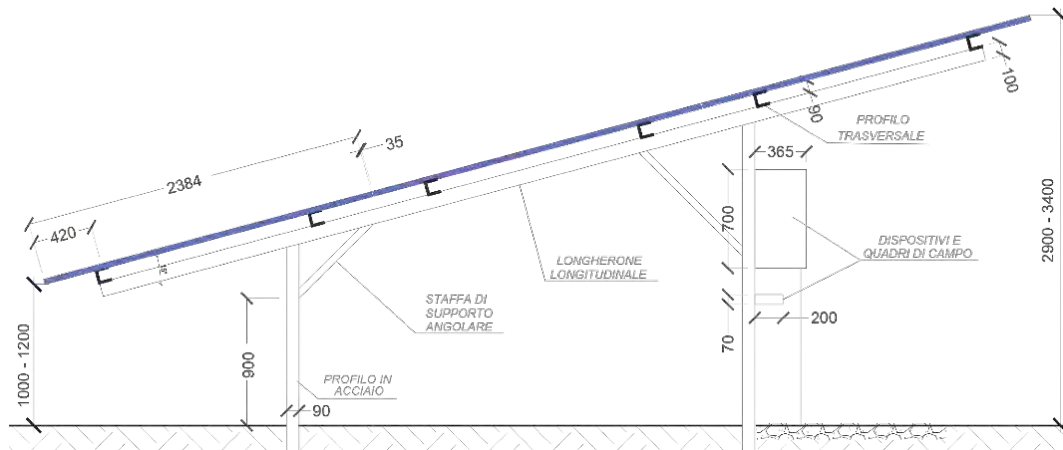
Schema di struttura fissa di progetto con moduli in silicio cristallino.
